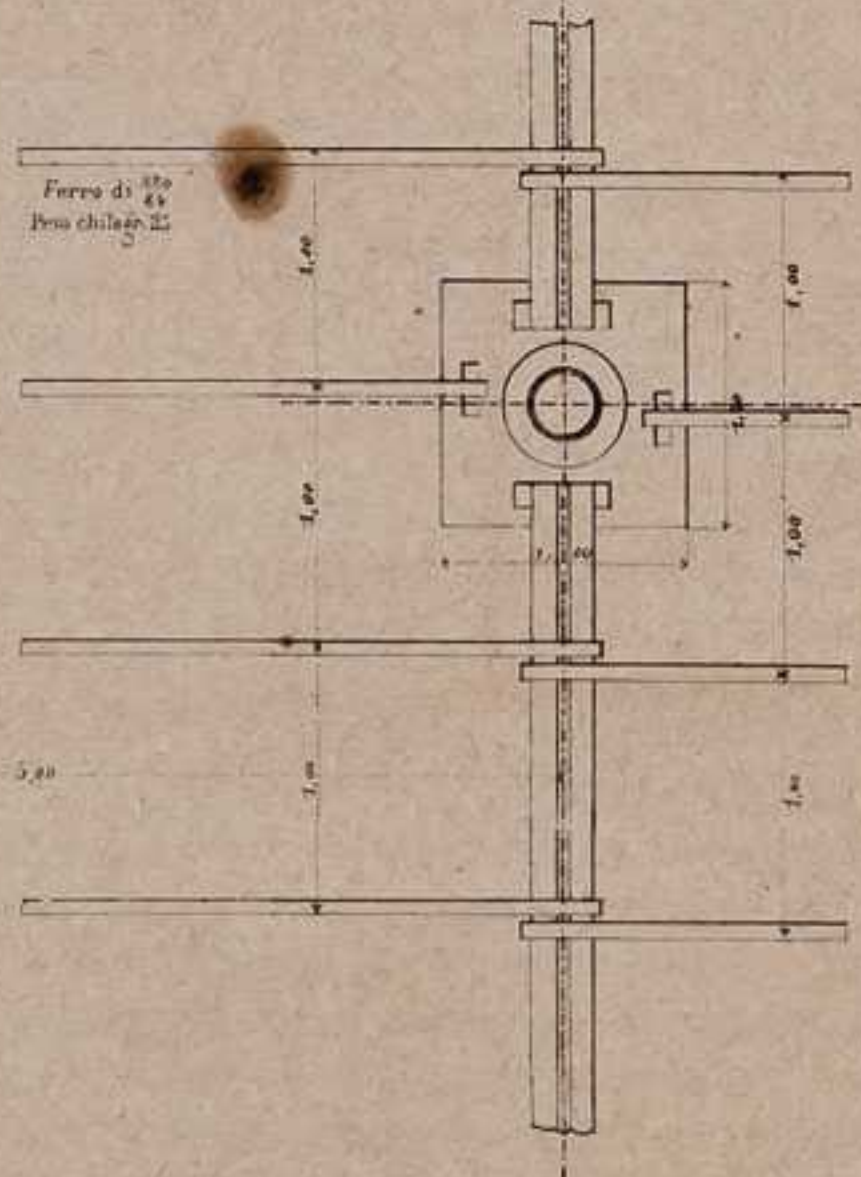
Proiezione orizzontale di un pilastro, e disposizione dei ferri.
